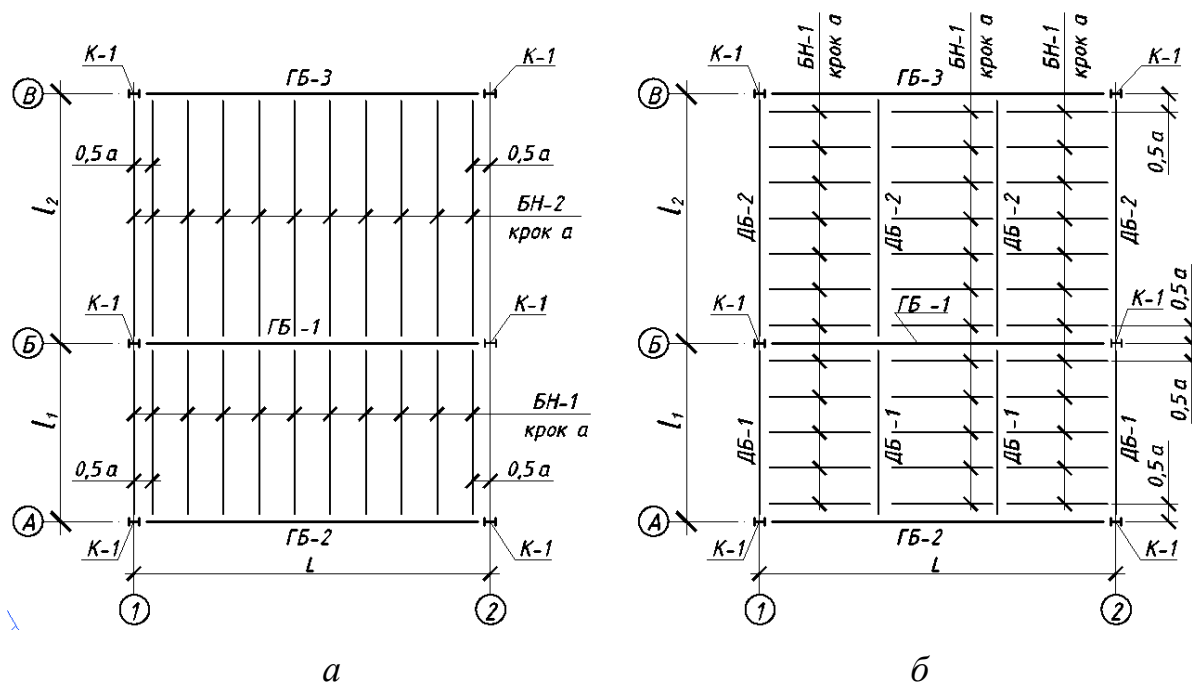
Схеми балкових кліток робочих площадок виробничих будівель:
